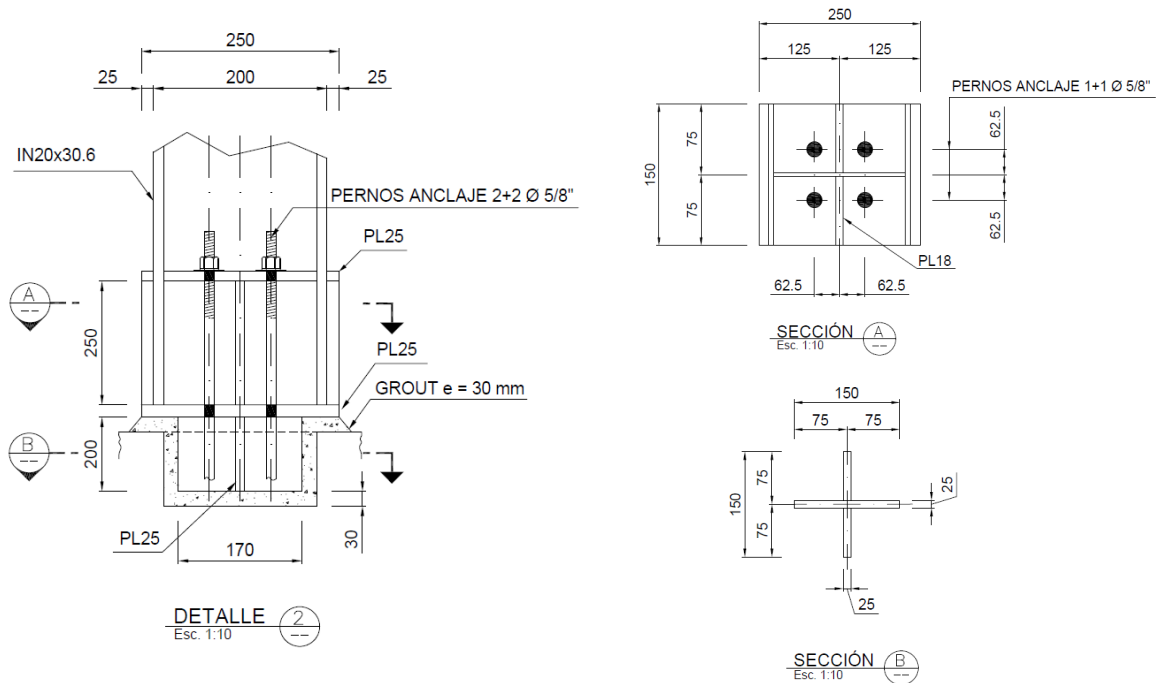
Detalle típico anclajes para columnas IN 20x30.6.
